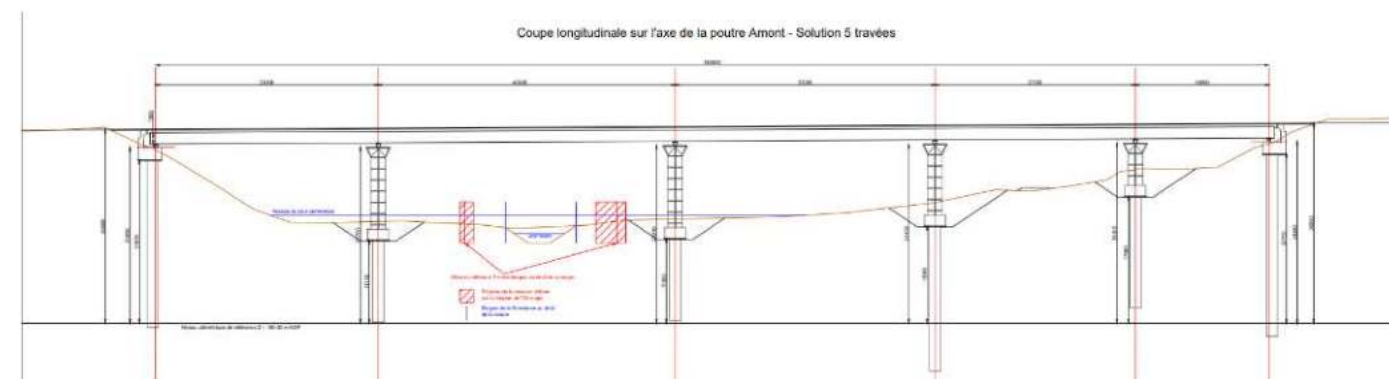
COUPE LONGITUDINALE SUR L'AXE DE LA POUTRE AMONT – SOLUTION A 5 TRAVEES (SOURCE : CEREMA)
